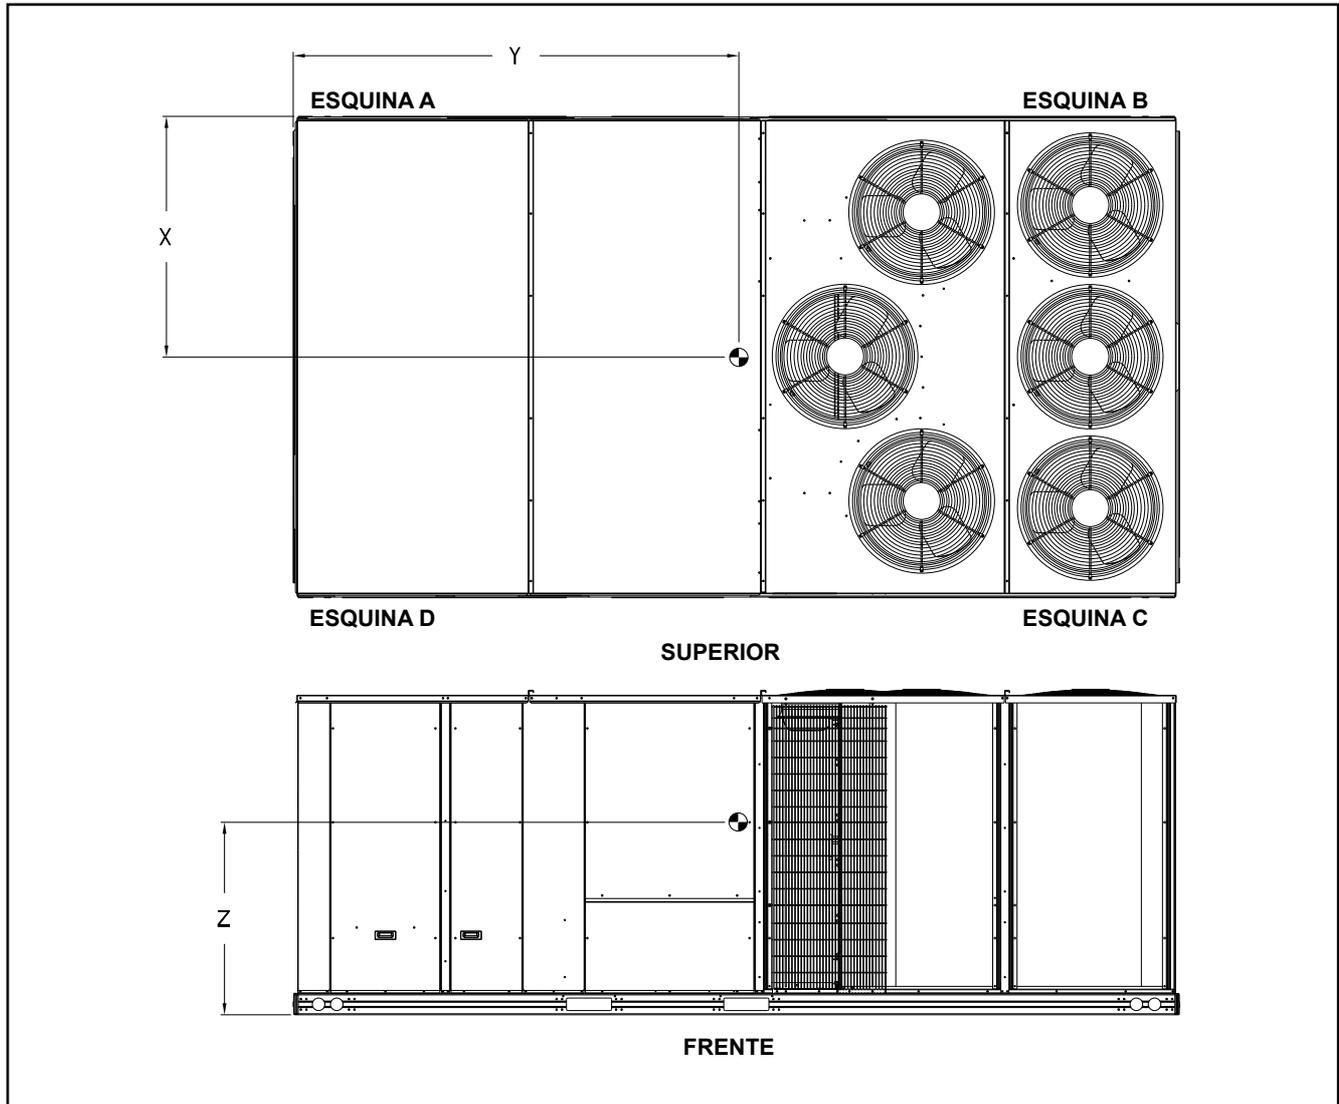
Dibujo dimensional de la unidad - 552EZ370
